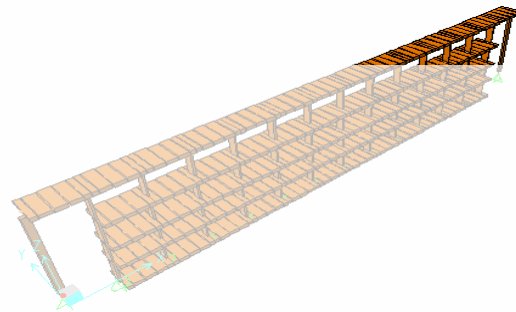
Modelo estrutural do Pórtico B (vigas-faixa): direção Norte-Sul (SAP2000).
